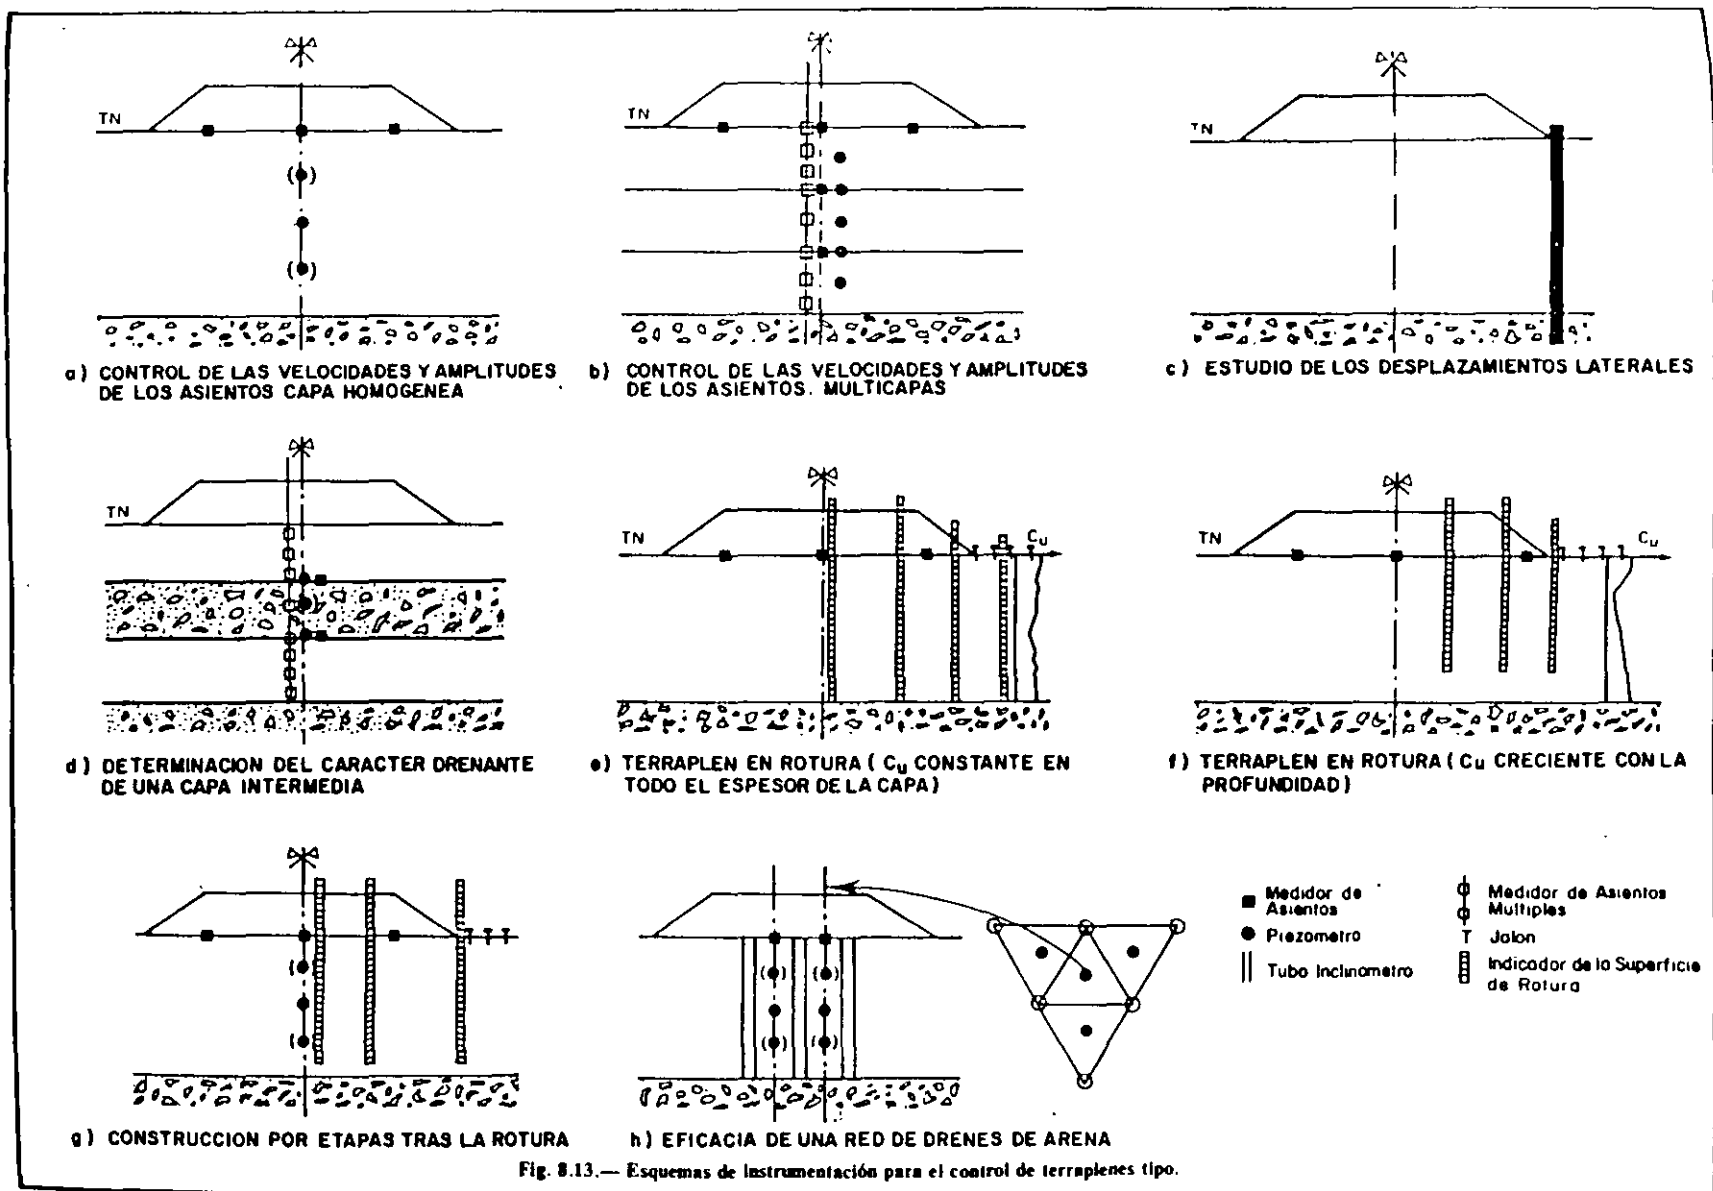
Esquemas de instrumentación para el control de terraplenes tipo.
